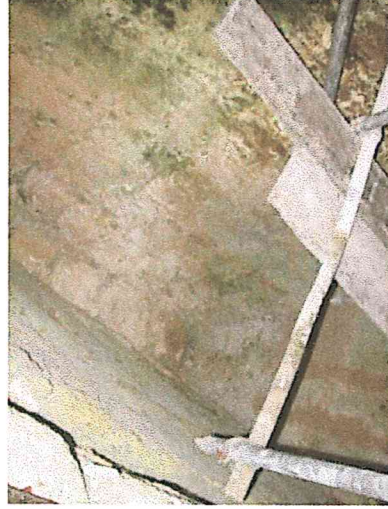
, Vista del muro Este de bóveda, cámara No.11, antes de la intervención
